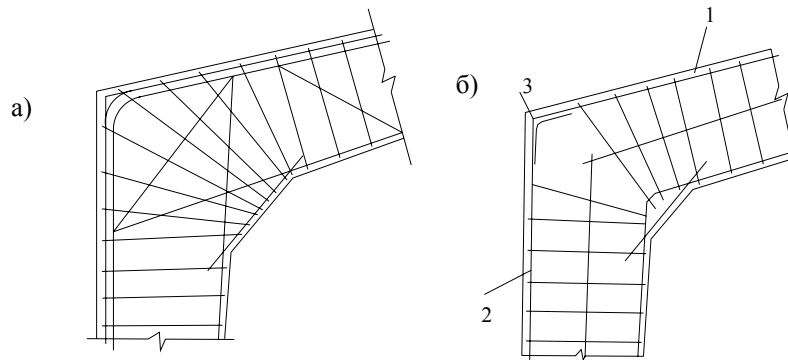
Армування вузла з'єднання зі стійкою:
